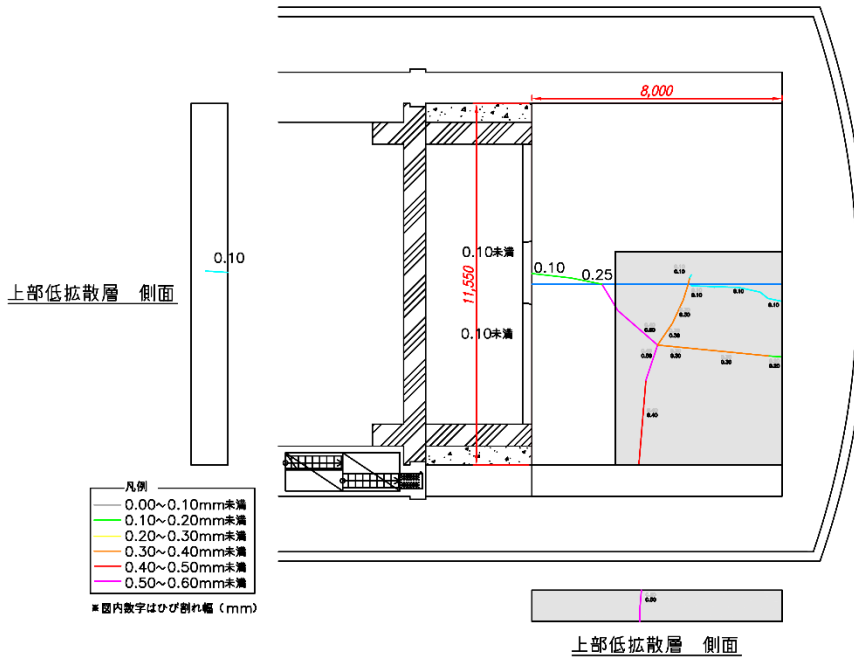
上部コンクリートピットおよび上部低拡散層のひび割れ履歴図 (その 4)
